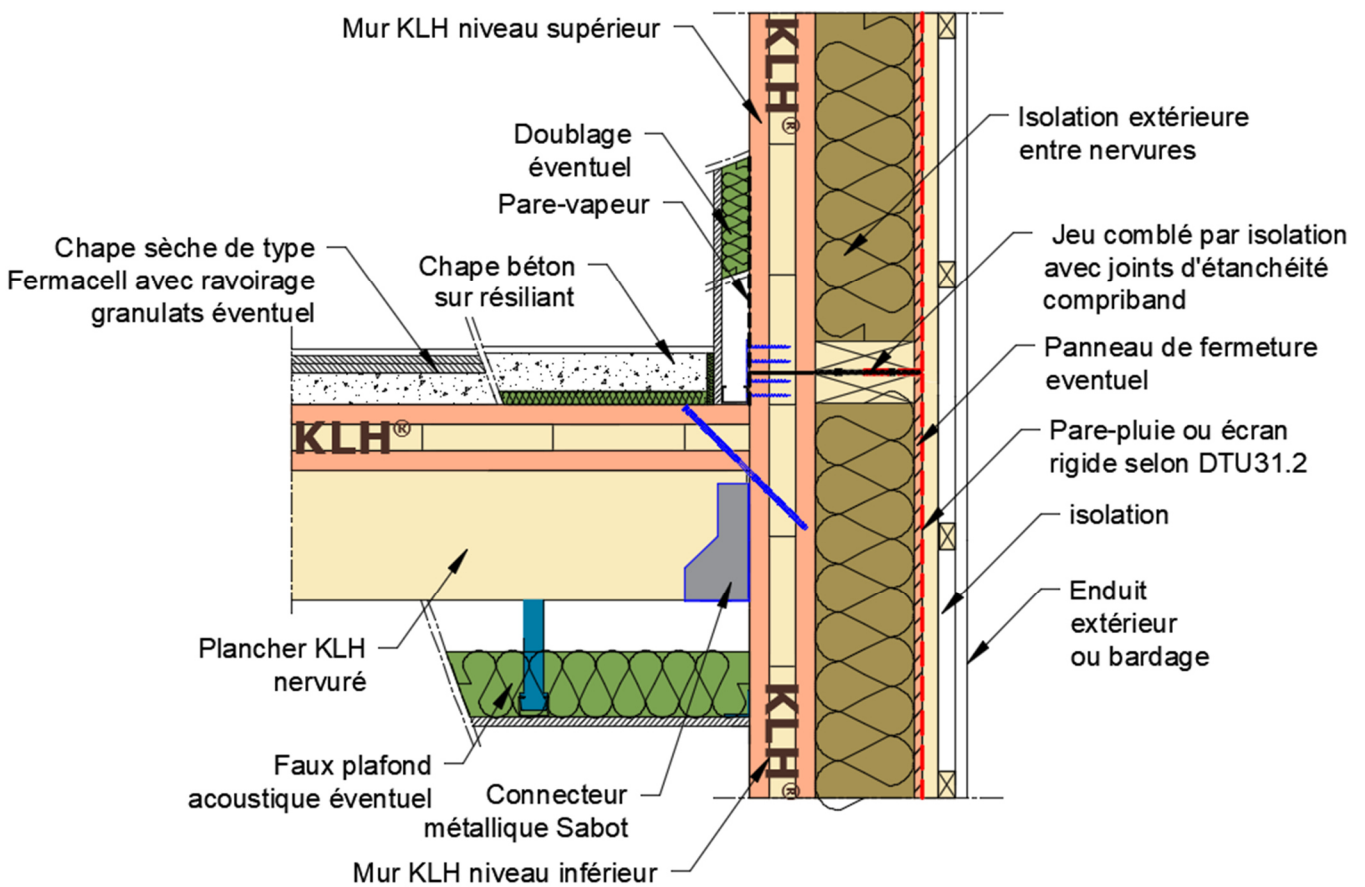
Exemple de coupe verticale plancher nervuré T reposant sur Mur extérieur KLH®-CLT nervuré T
